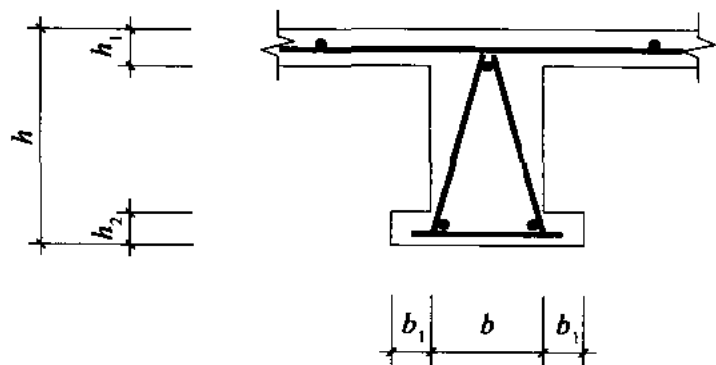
叠合密肋楼板局部剖面构造示意图
